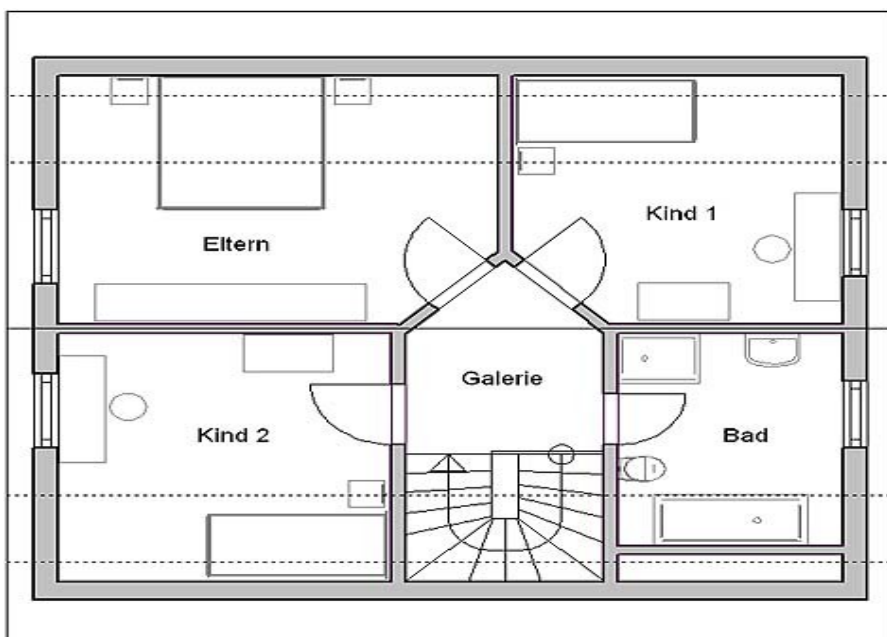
Haus: Grundriss Dachgeschoss [PRO2010]
